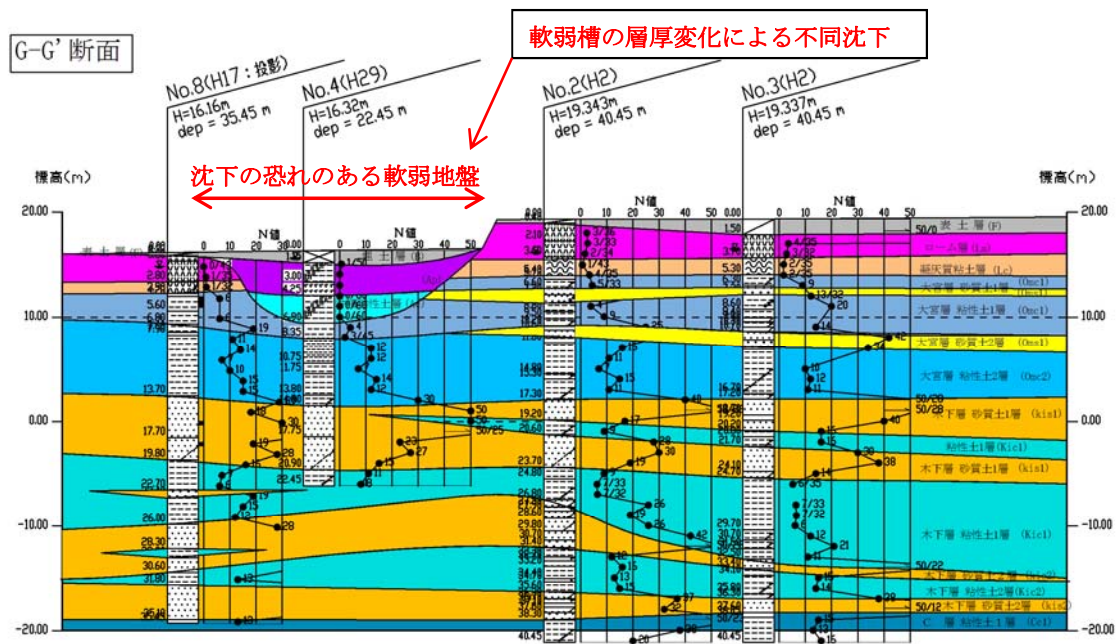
地層推定模式断面図 (G-G' 断面)
